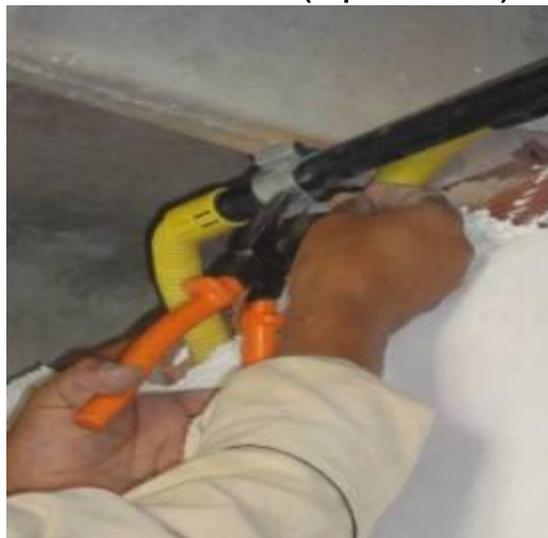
Fixação dos eletrodutos rígidos no teto (superestrutura)
